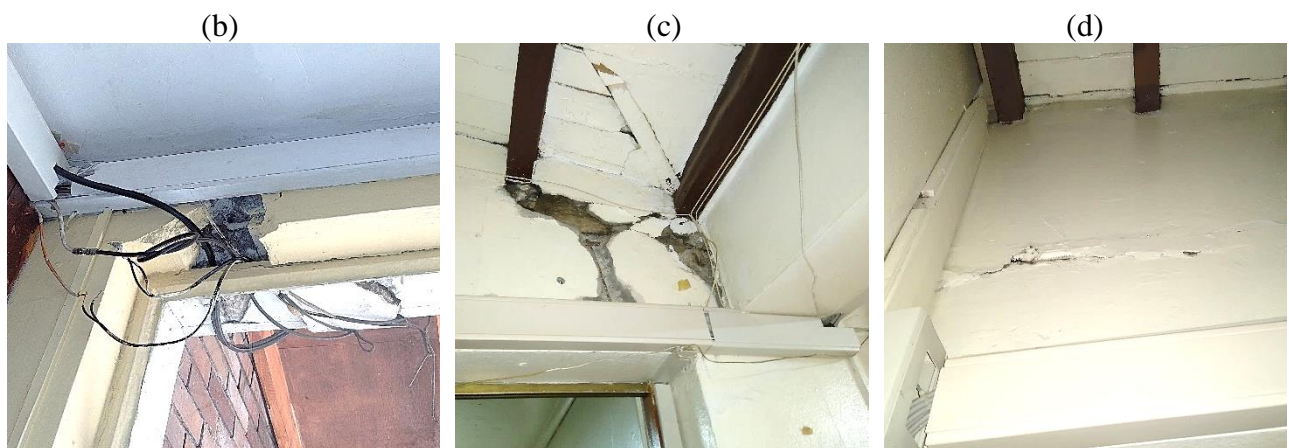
7 Grietas elevación eje 4: (b), (c) y (d) de Fig. A.4.5.1.6(a) y A.4.5.1.8.
